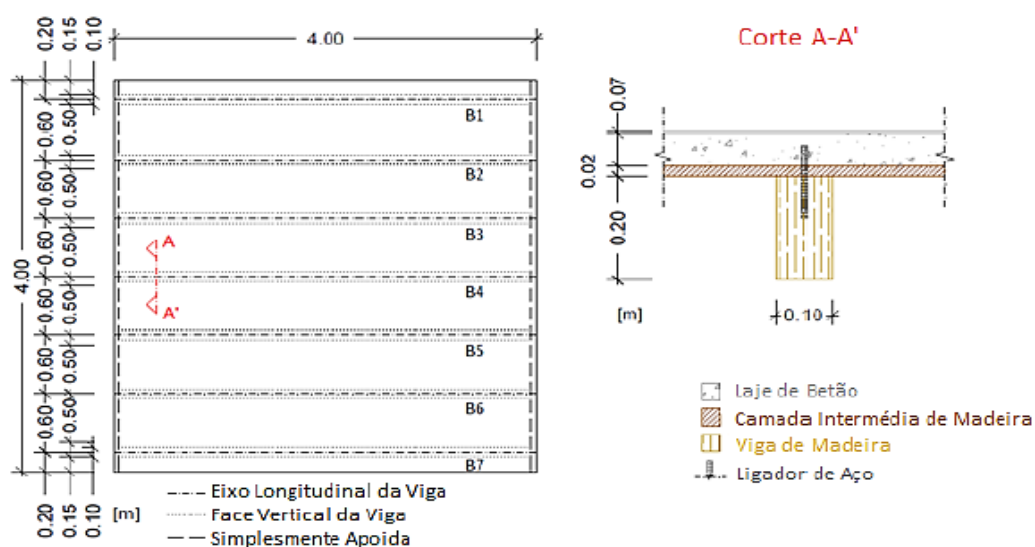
Planta e Corte do modelo base: Características Geométricas (Campos, 2016)
